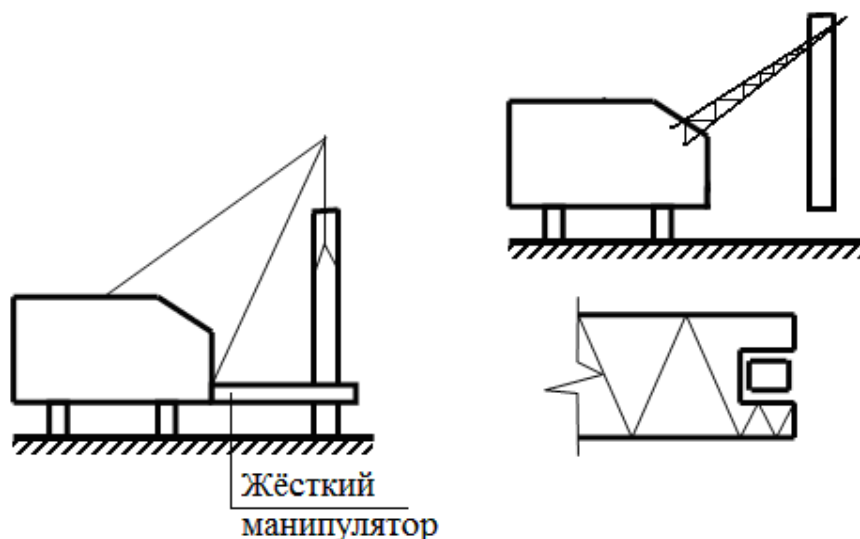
Дополнительное оборудование крана для монтажа колонн
